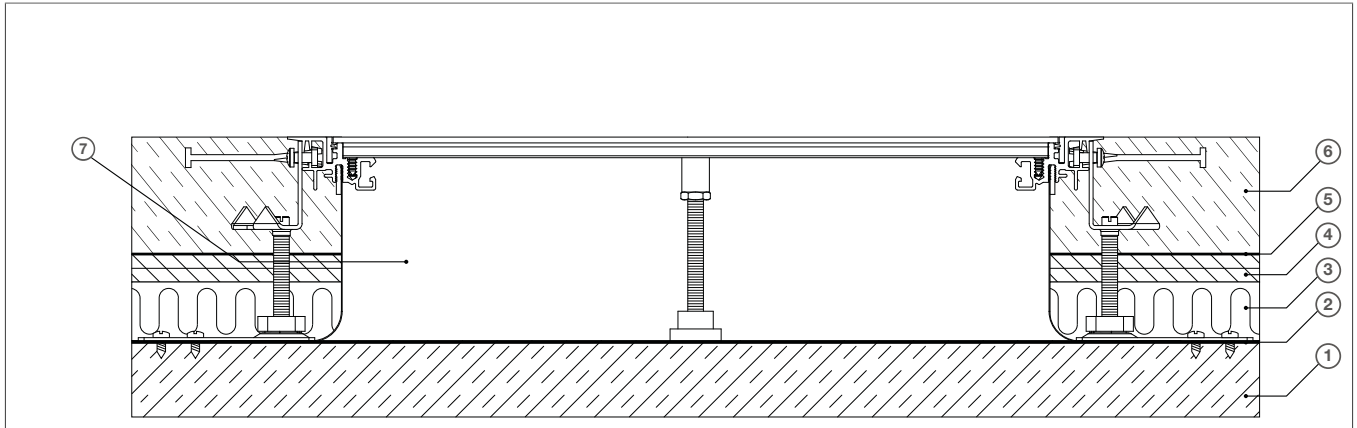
Prinzipskizze Prüfaufbau estrichbündiger Kanal BKFx im Deckenprüfstand
